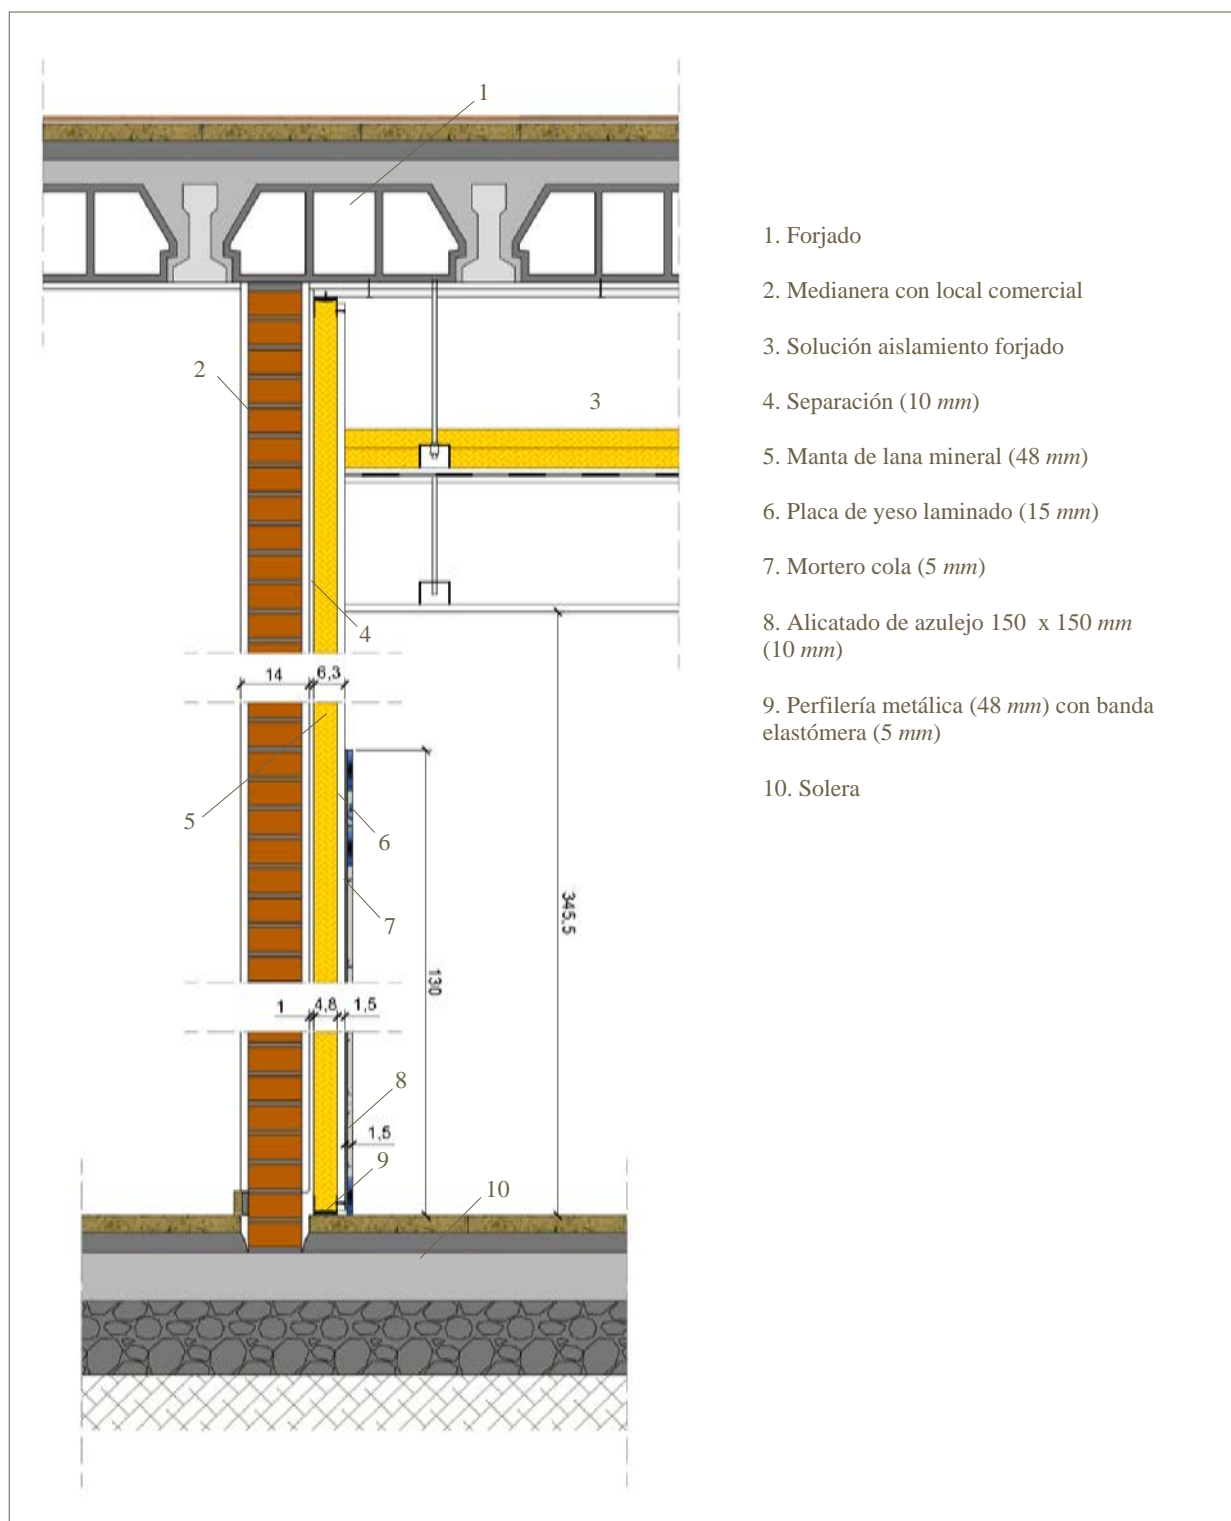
Detalle constructivo solución aislamiento medianera con local comercial
